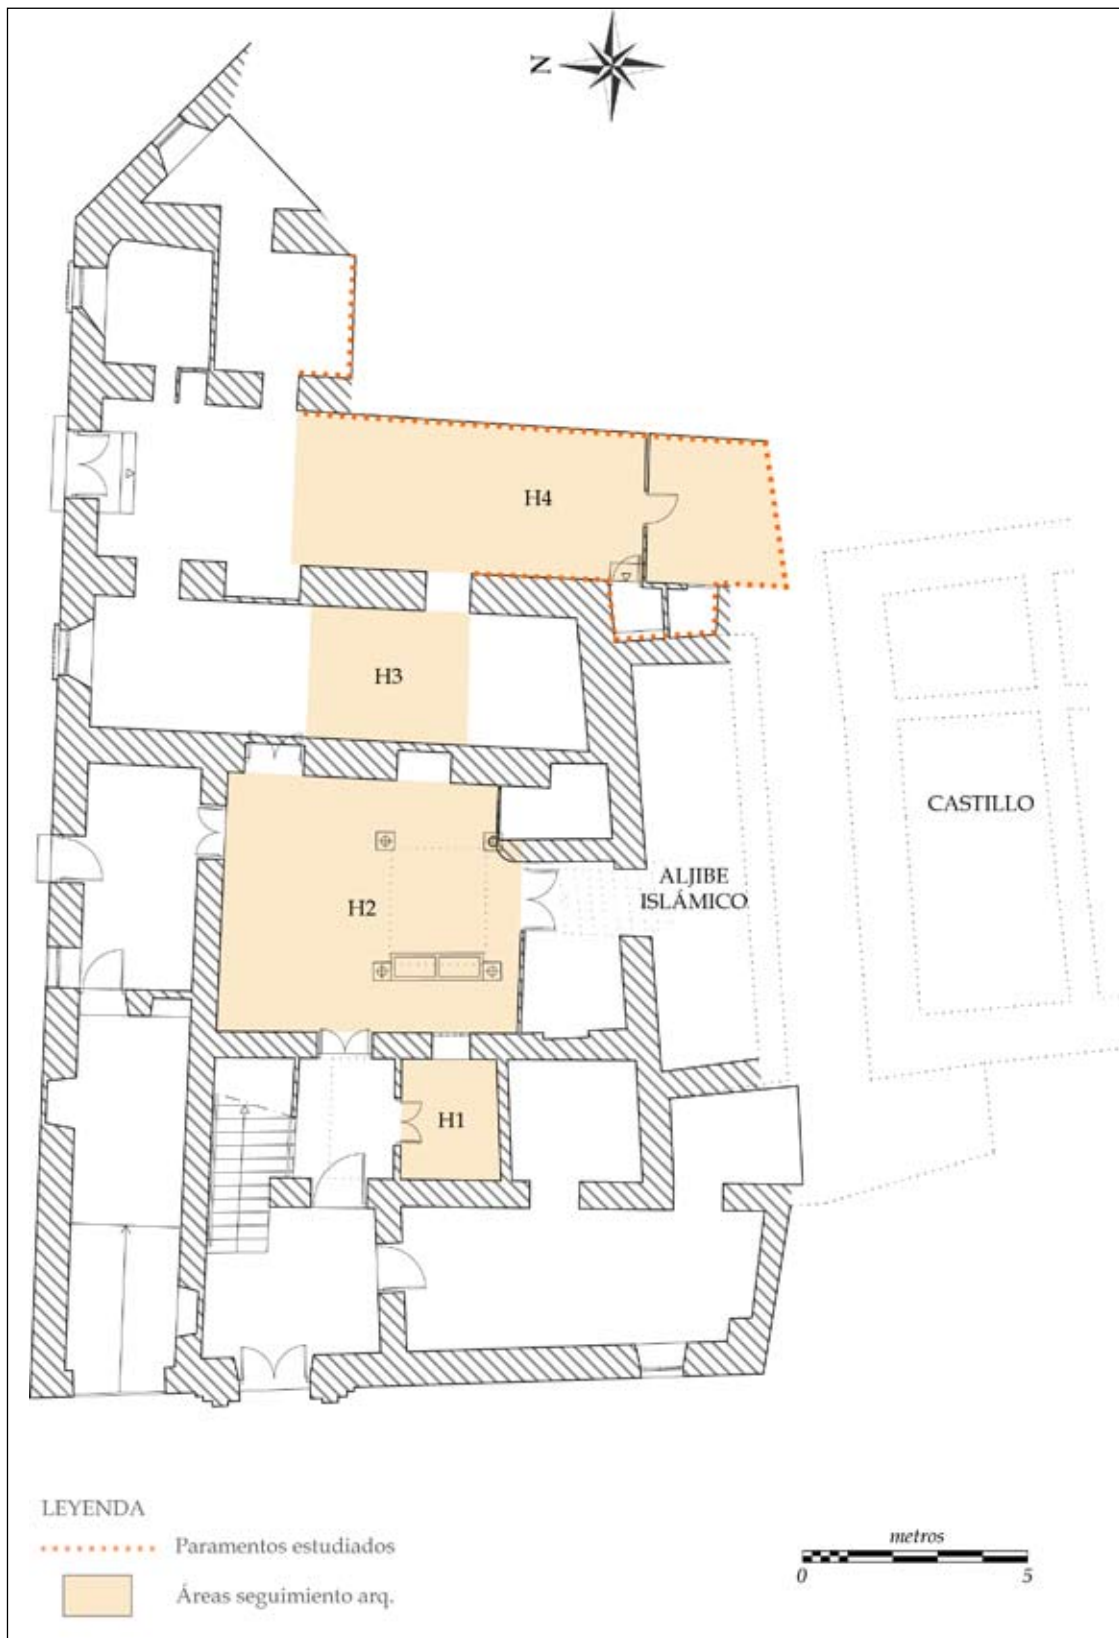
Planta baja de la casa solariega con indicación de las zonas de actuación.
